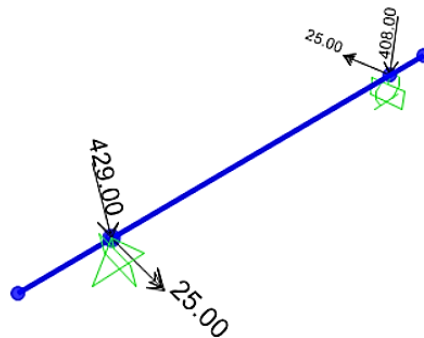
Esforços da Estrutura Metálica sobre a sapata
